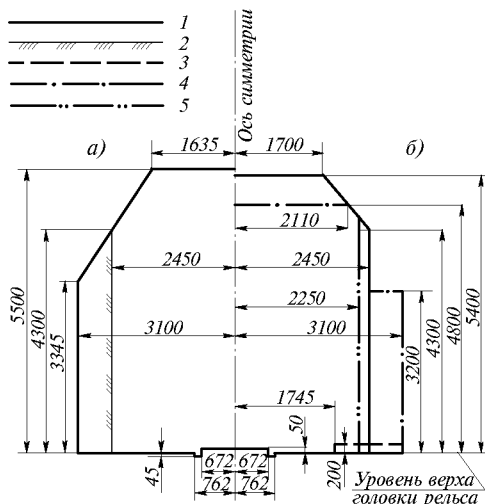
Габариты приближения строений на железнодорожных путях доменного цеха *а* – вне зданий; *б* – внутри зданий; 1 – основные очертания габаритов; 2 – линии приближения отдельно стоящих колонн, опор и выступающих частей зданий и сооружений при их протяженности вдоль путей не более 1000 мм, сооружений для туннелей, мостов и эстакад; 3 – линия приближения фундаментов сооружений; 4 – линия приближения сооружений на отдельных участках постановочных железнодорожных путей, по которым пропуск подвижного состава высотой более 4700 мм не предусматривается, и для железнодорожных путей литейных дворов в пределах крайних колонн; 5 – линия приближения в литейных дворах отдельно стоящих частей зданий при их протяженности вдоль путей не более 1000 мм
